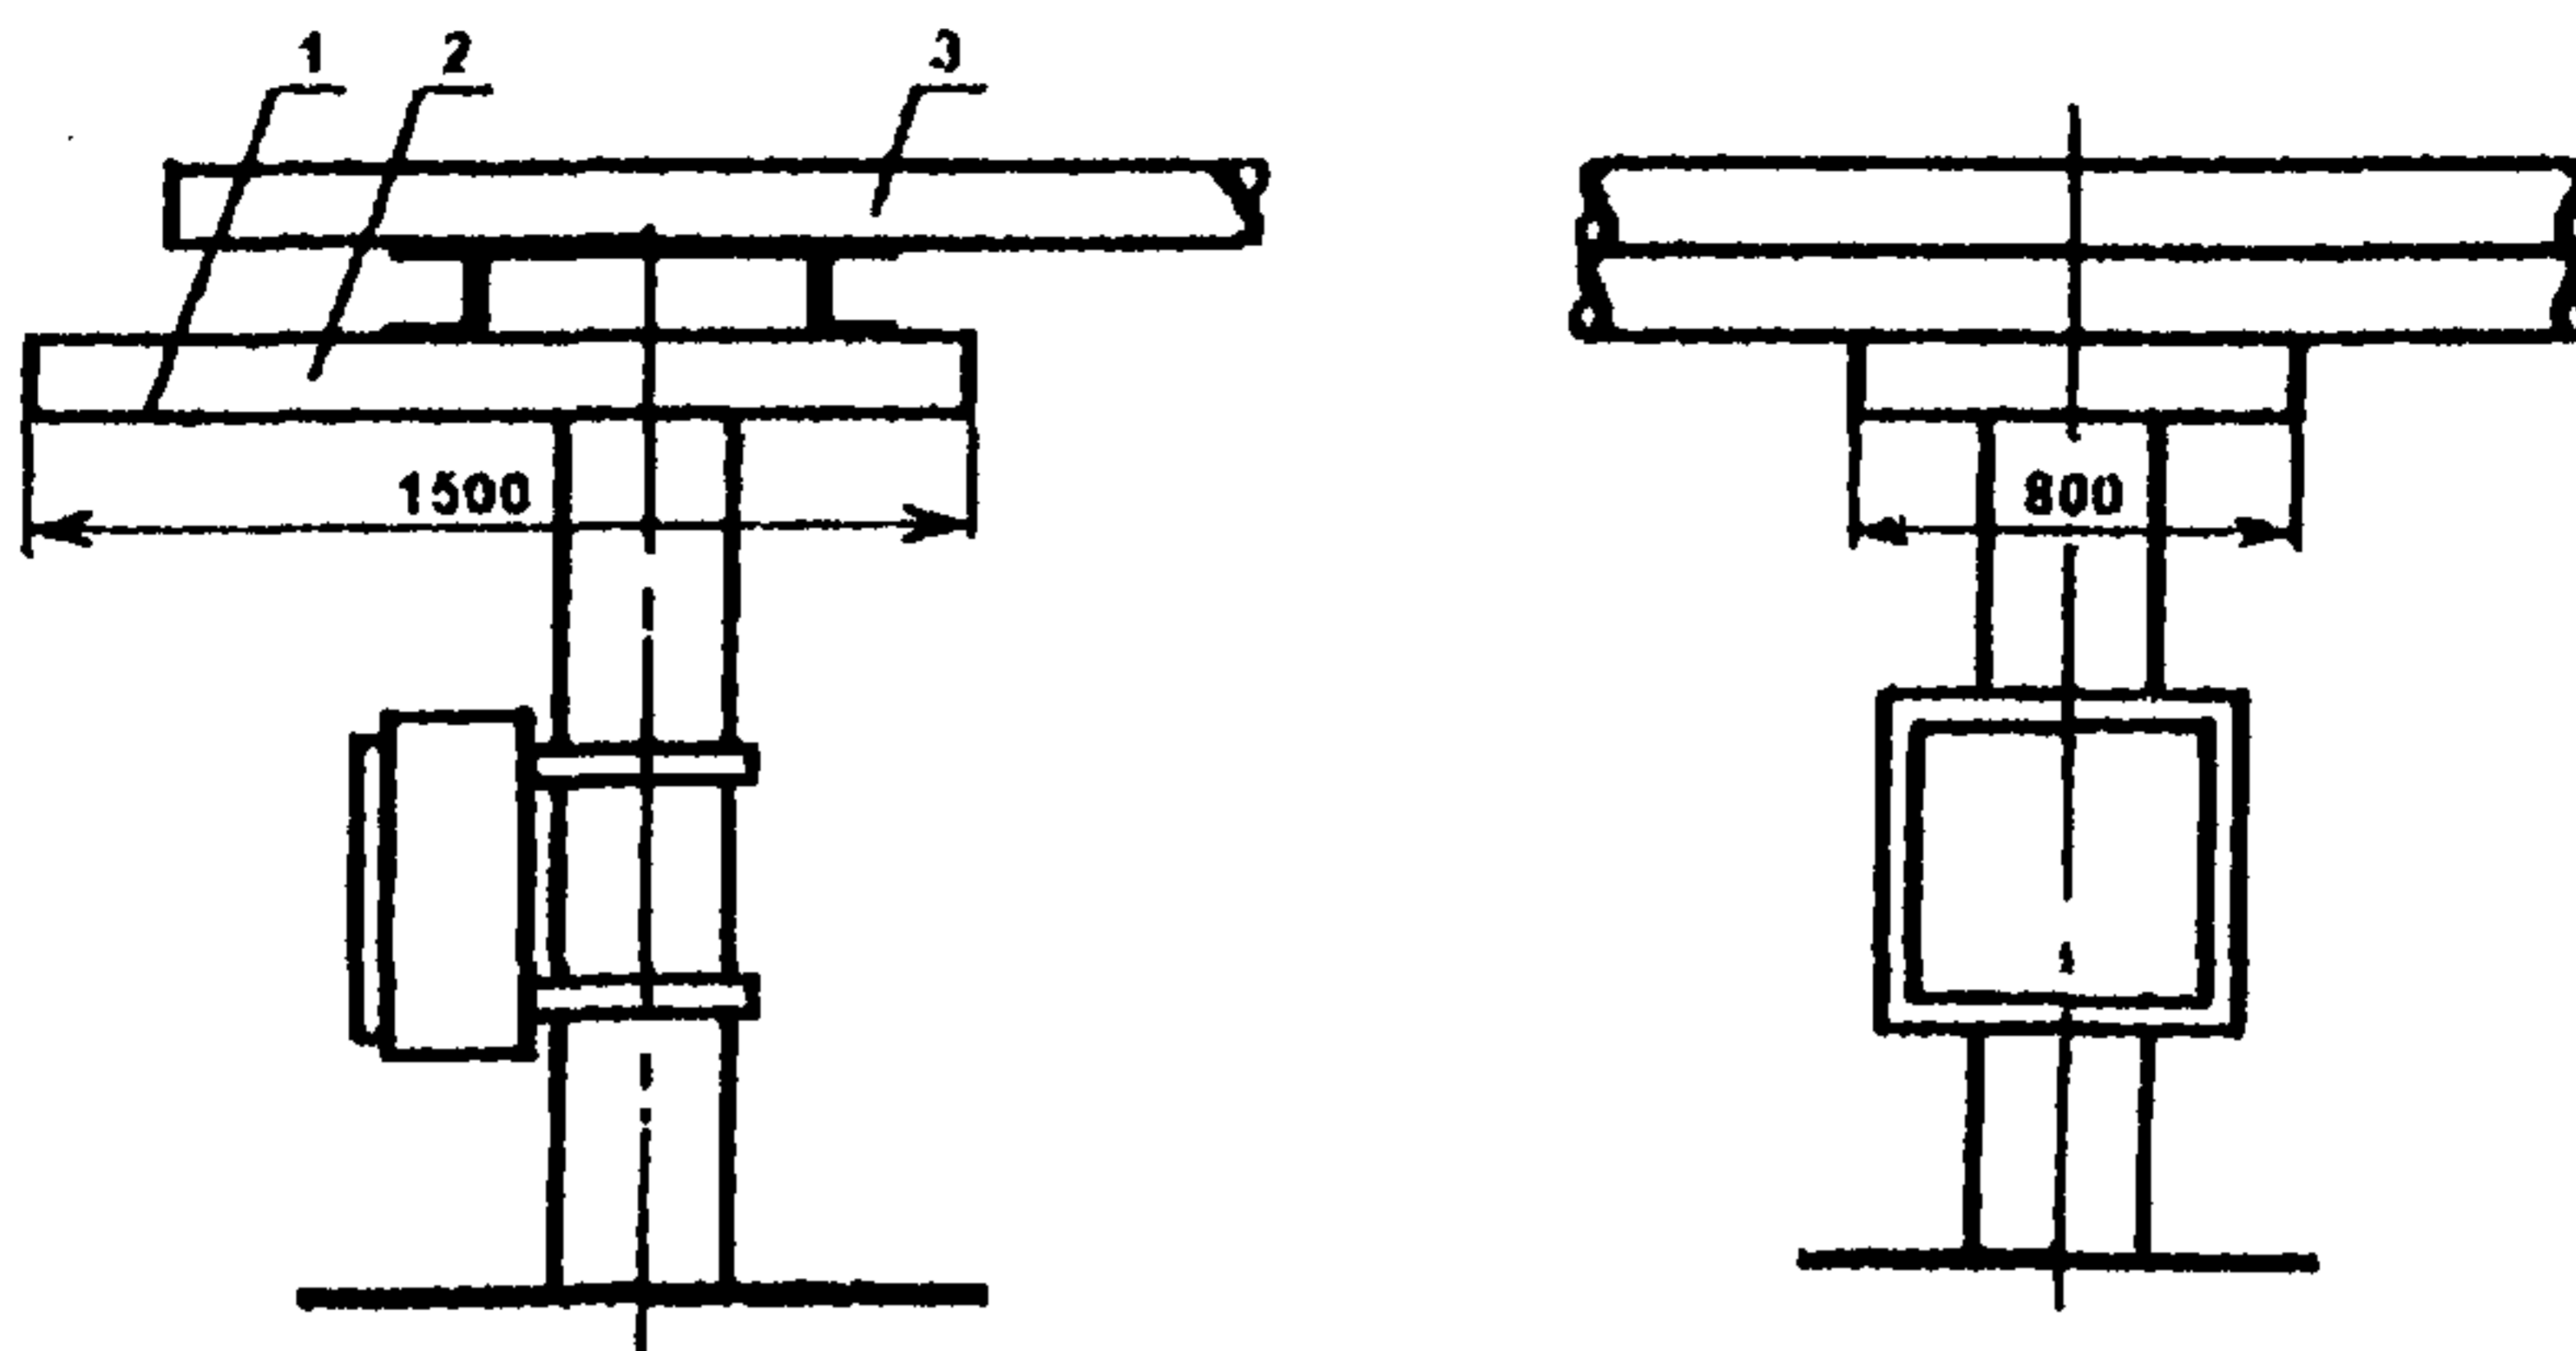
Установка защитных козырьков над ручными приводами разъединителей серии РНД (3):
